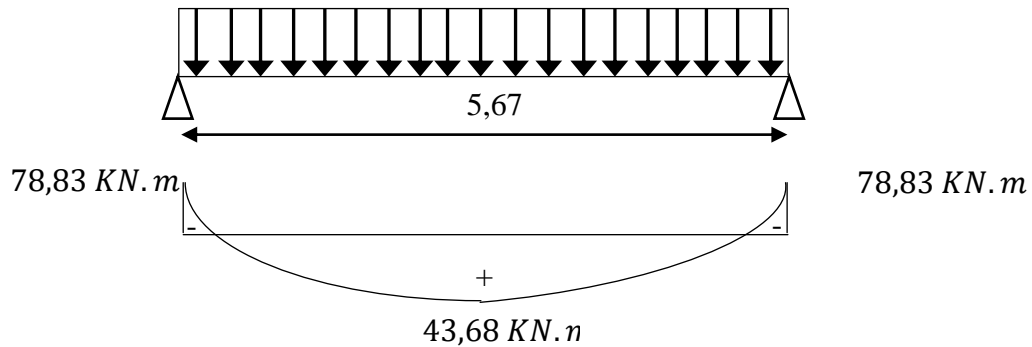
Schéma statique de la poutre palière de l'escalier
